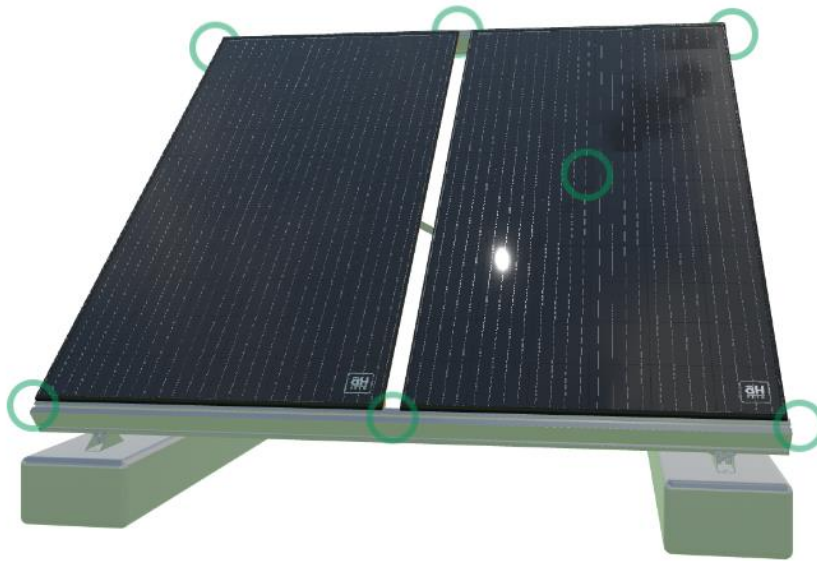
Ejemplo de la separación entre paneles. Fuente: Ahora Solar.
